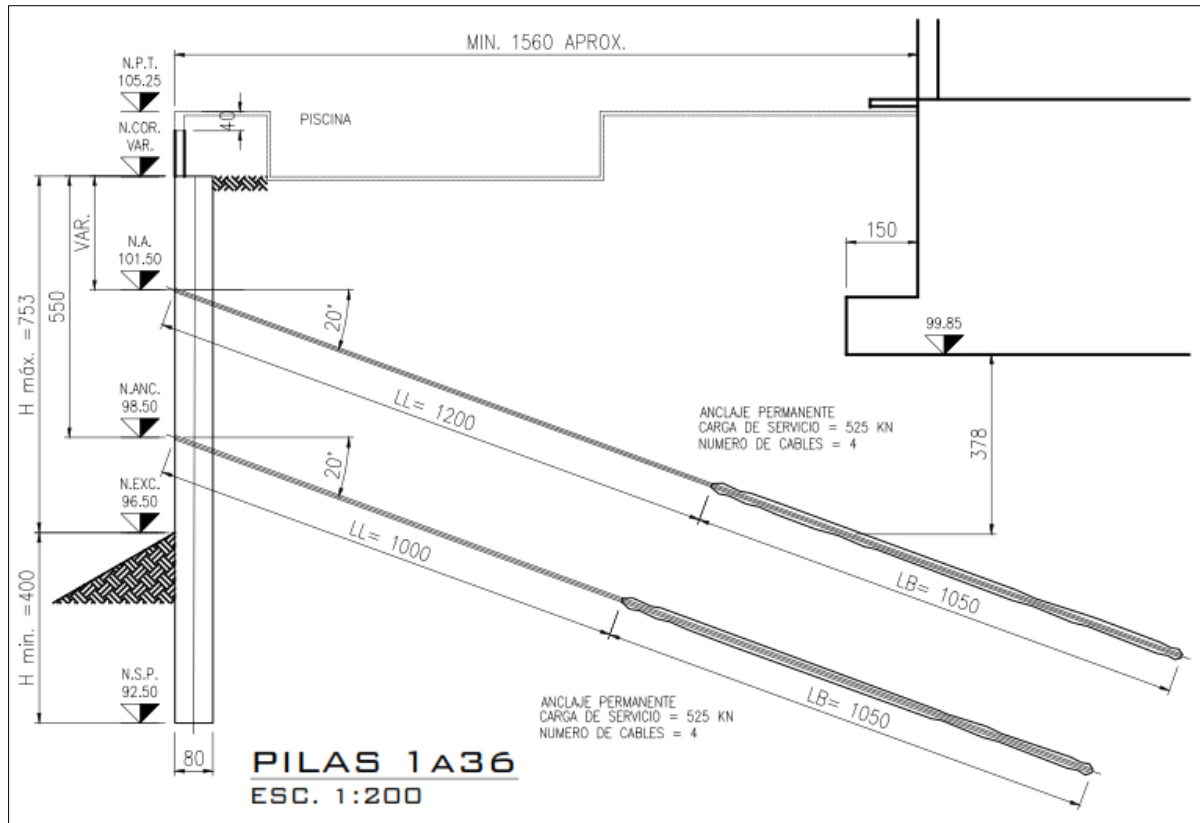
Anclajes en pilas 10 y 30, plano Ferrara Ingeniería y Construcción.
